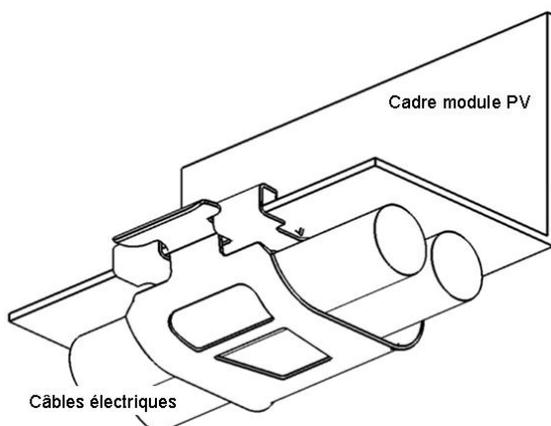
fixation des câbles sur le retour du cadre des modules PV
